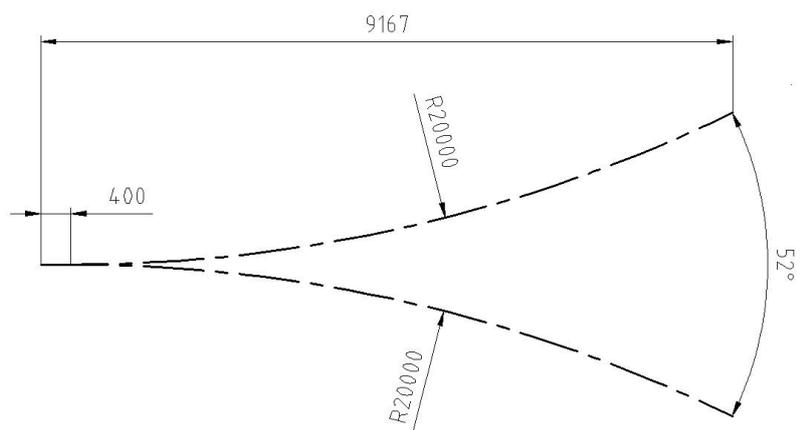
平移型对开道岔线型(尺寸单位: mm)
